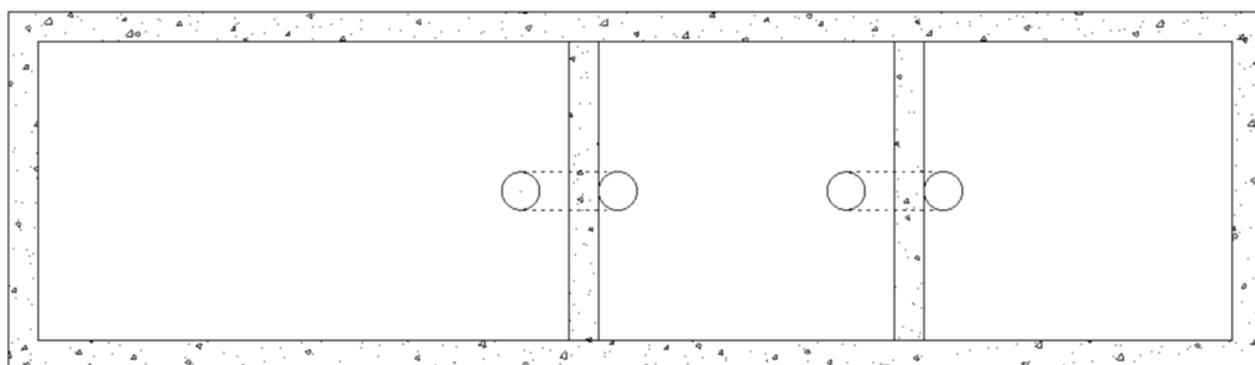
Trampa de grasa Italcol planta 1 vista planta
